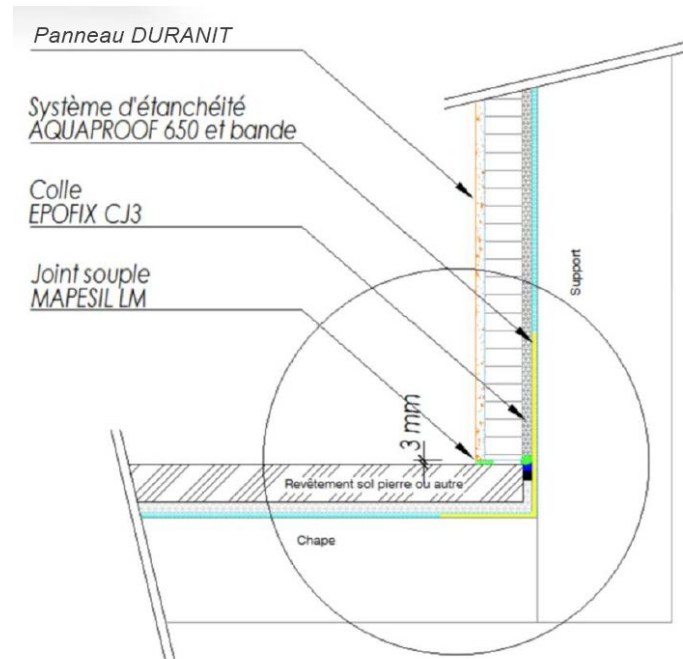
Raccordement dans le cas d'une douche accessible « zéro ressaut »
